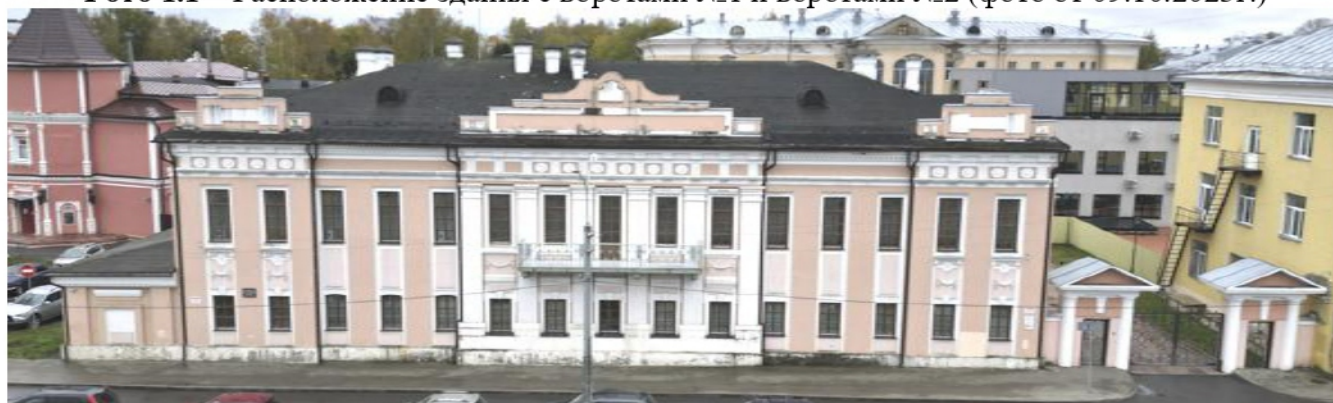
Главный фасад здания в осях 1-11/А-Б (фото от 09.10.2023г.)
